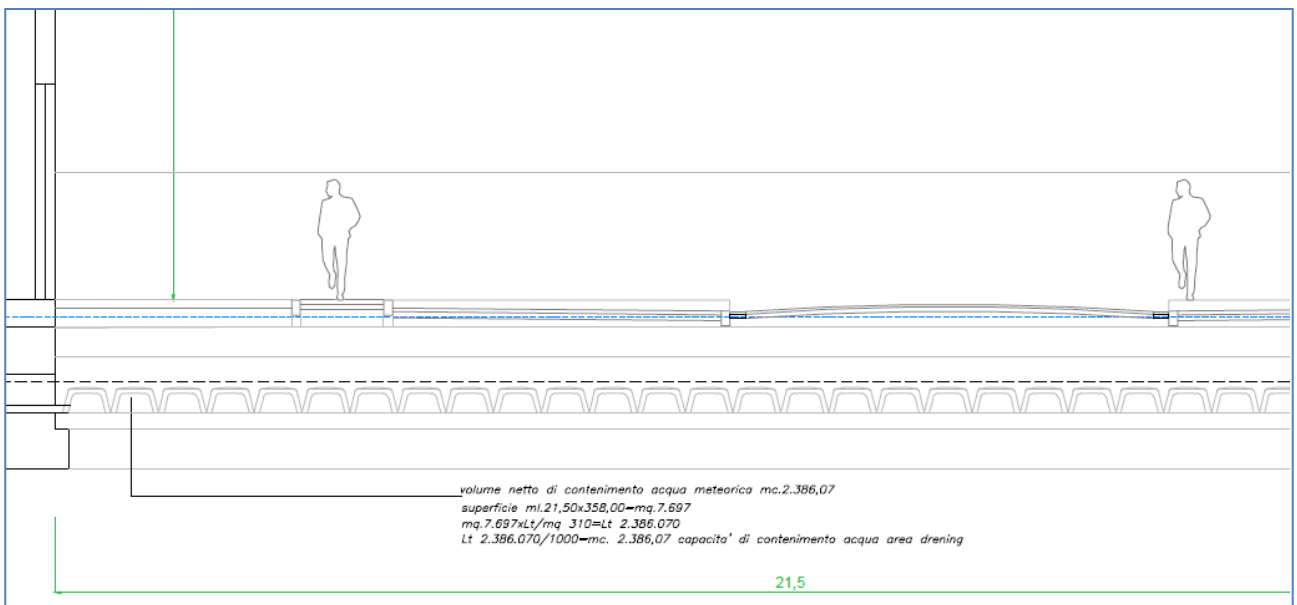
Sezione tipo di capannone e parcheggio con drenage (particolare)
